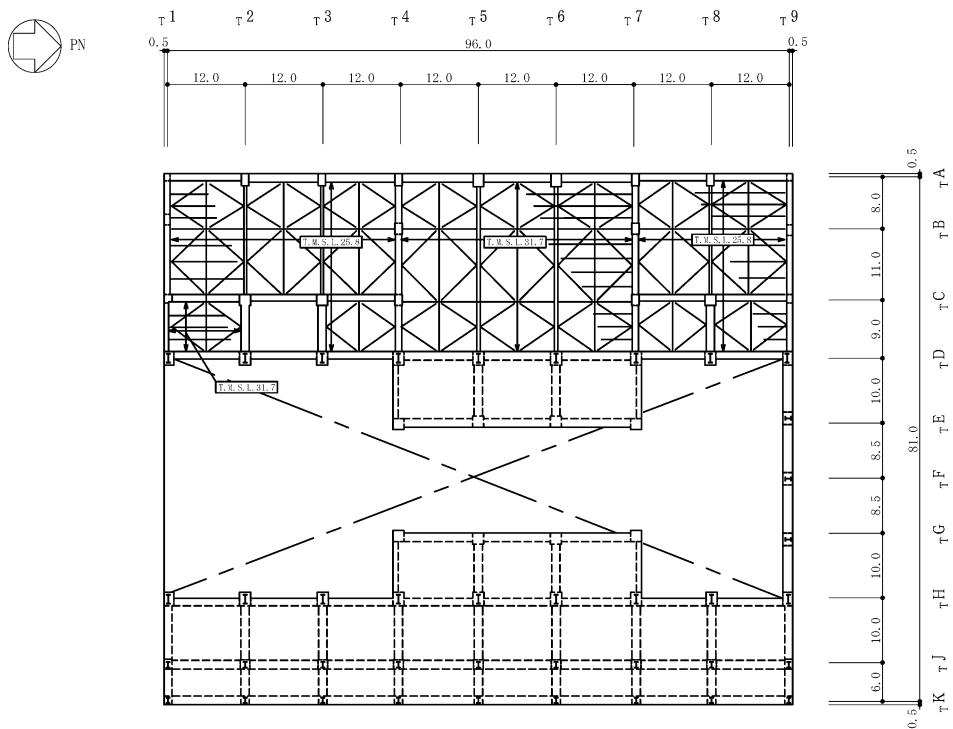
タービン建屋の概略平面図 (3F, T.M.S.L. 30.9m) (5/6) (単位 : m)
